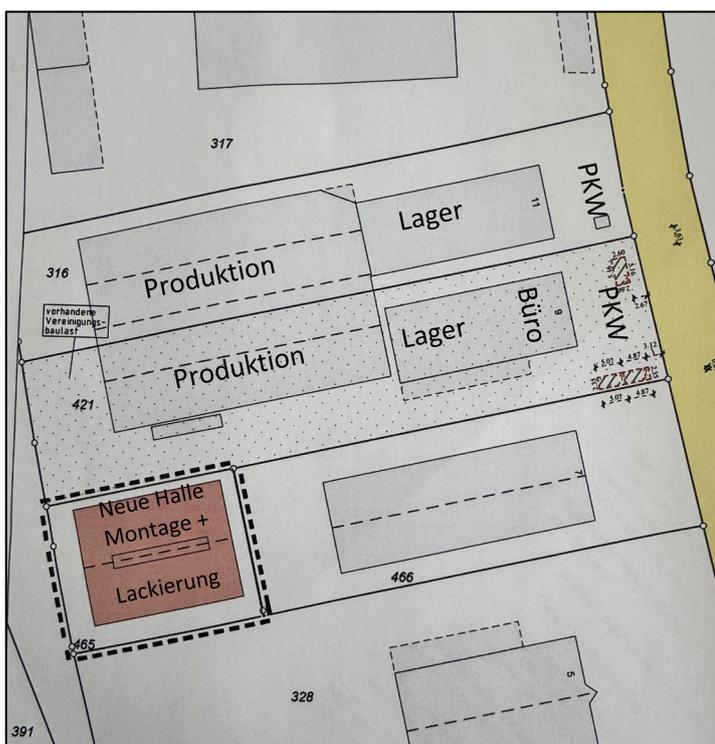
Lageplan Becklönne Maschinenbau GmbH & Co. KG
